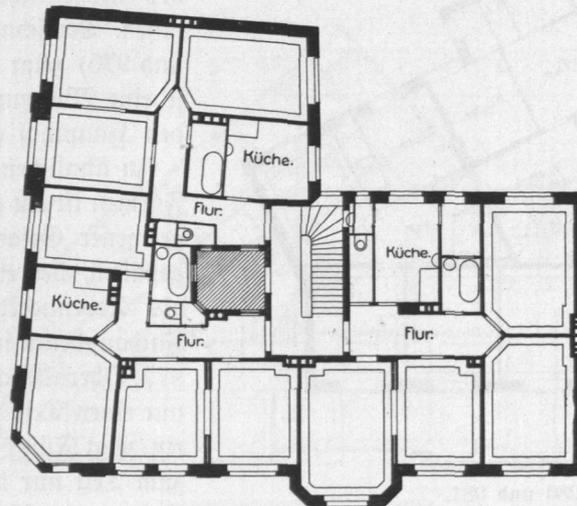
Haus Ecke Böhmenstraße und Englische Planke, Obergeschoß.
